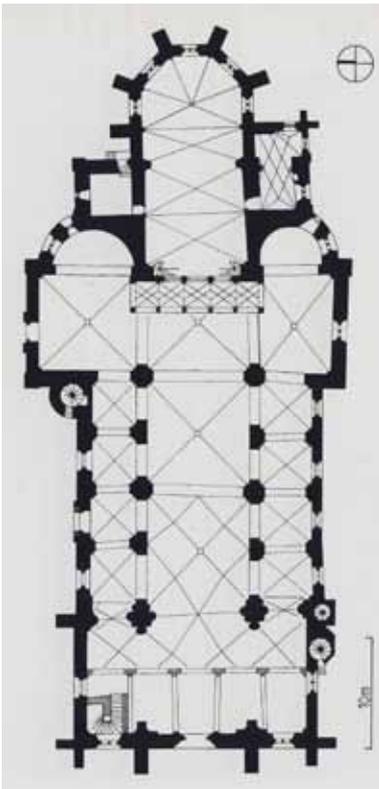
Grundriss des Breisacher Münsters, Lettner westlich vor den östlichen Vierungspfeilern
